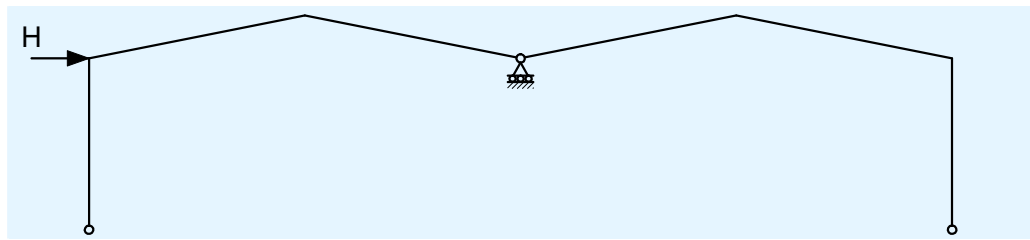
Subestructuras para una estructura típica de dos naves adosadas
